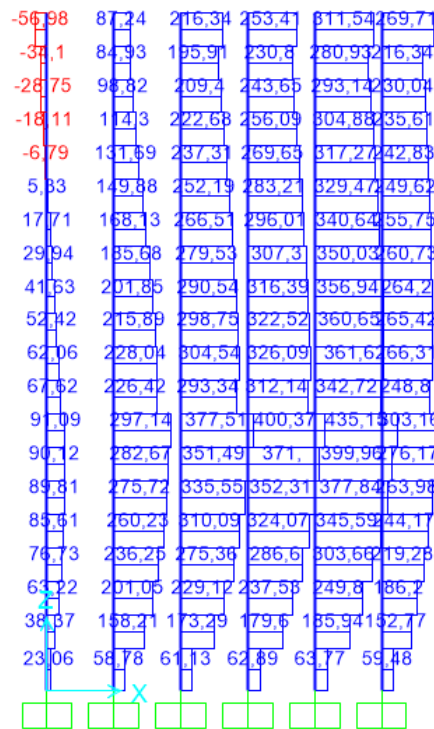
Esfuerzos cortantes en columnas, pórtico C
